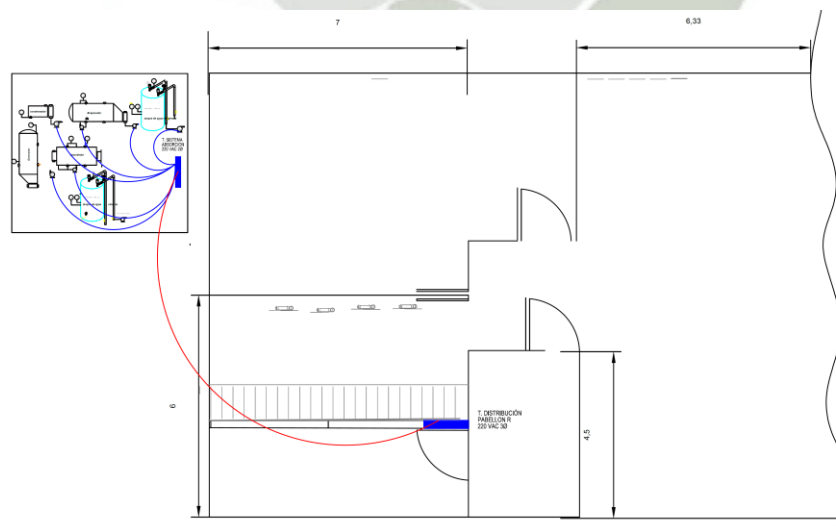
Primera planta, ubicado tablero eléctrico pabellón R
